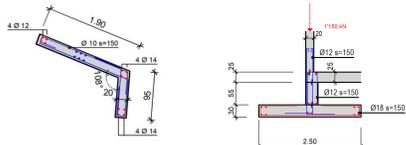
Details Wanddecke und Fundament (Allplan 2019).
